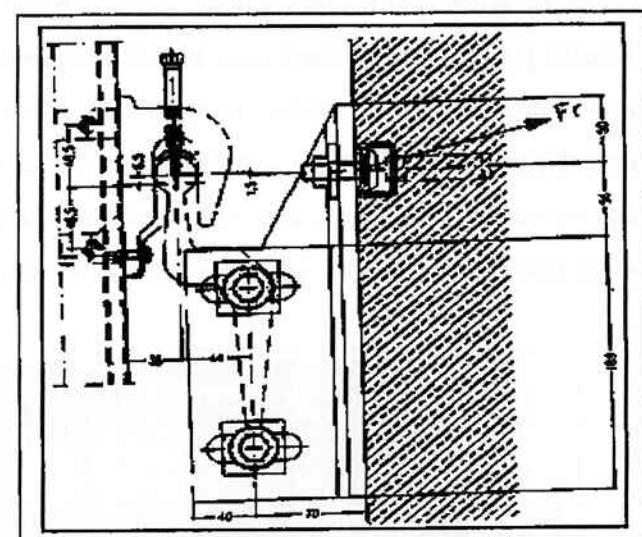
Gancho (elemento de fixação) na lateral da viga.
